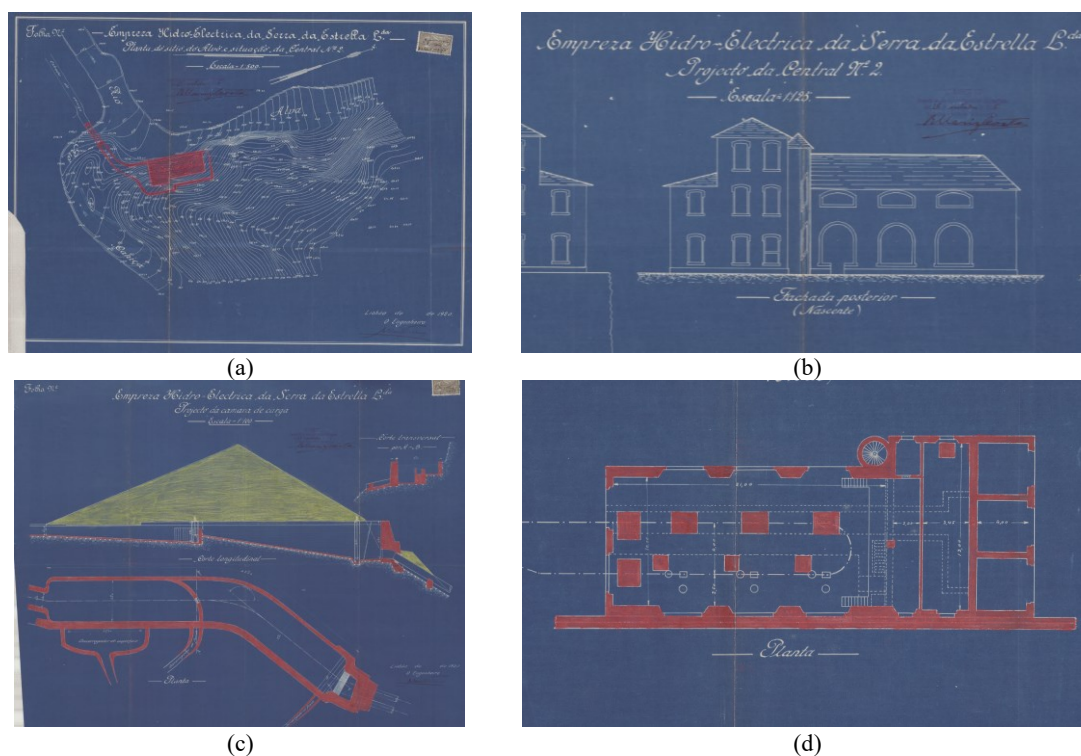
Peças desenhadas do projeto da central n.º2, ou Central da Caniça
